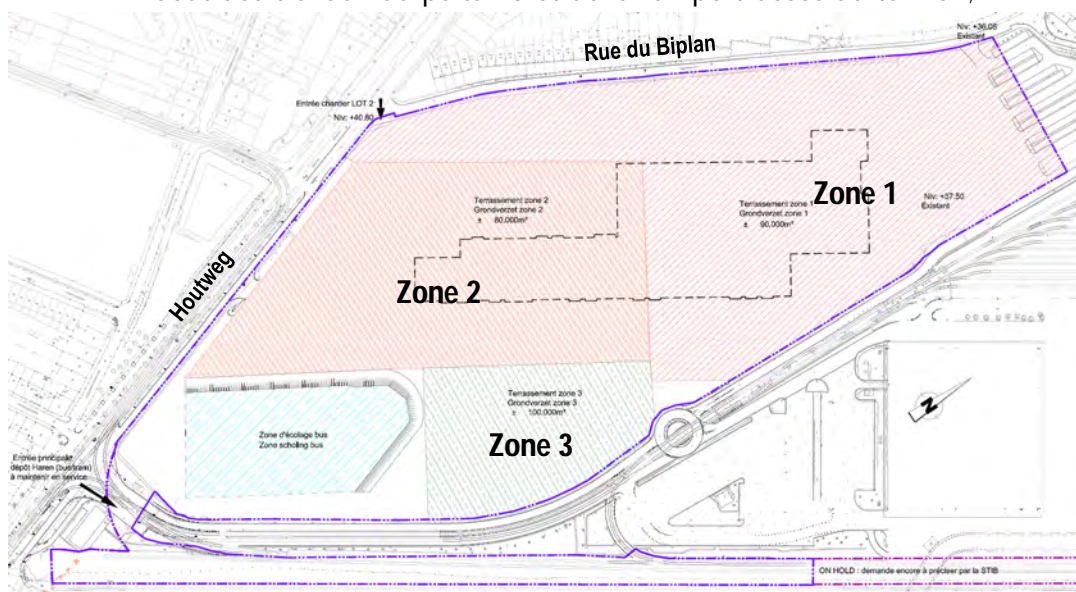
Localisation des zones de terrassement (plan phase 2) (ARIES, 2020, sur fond BMN, 2018)
